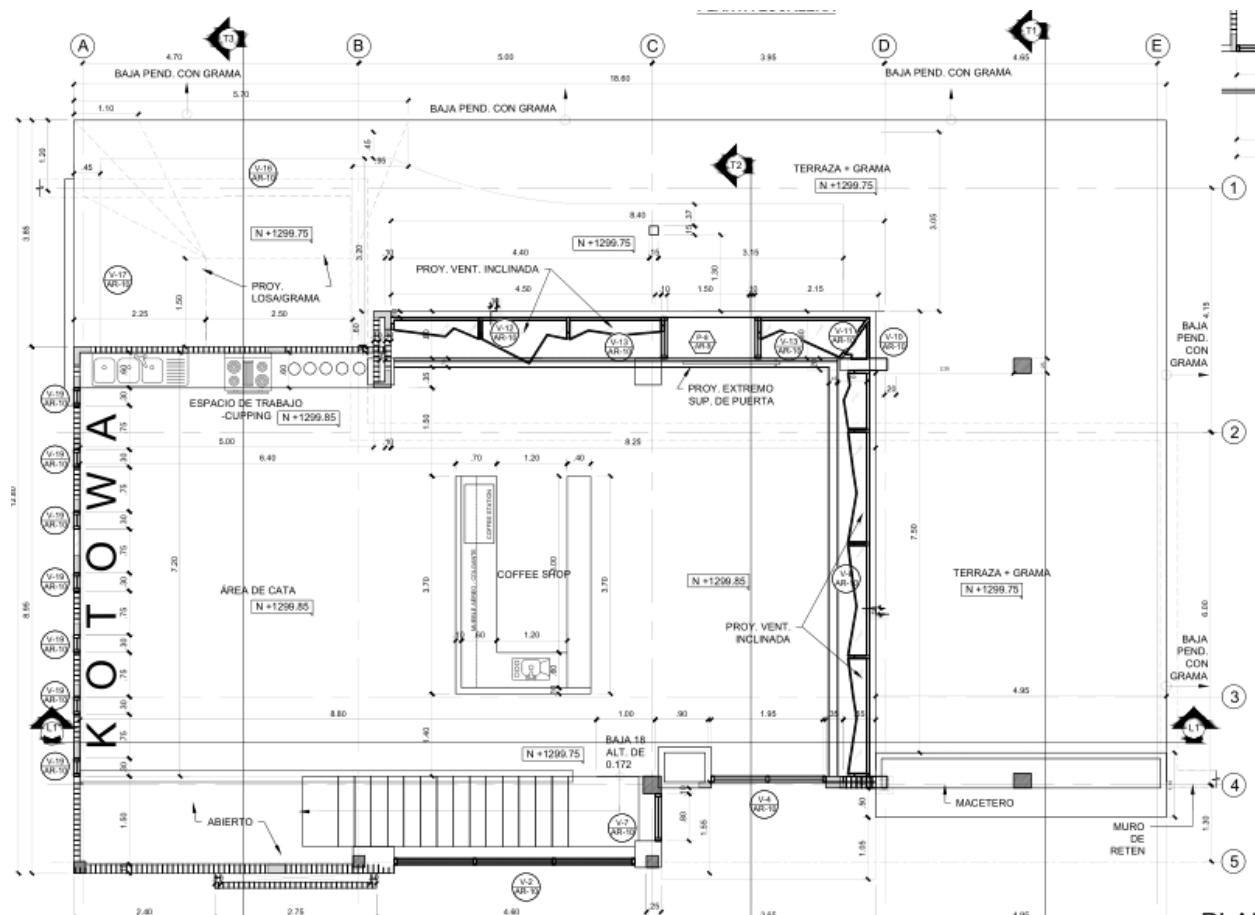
Planta arquitectónica nivel 200 – Edificio Gerencia / Cupping
